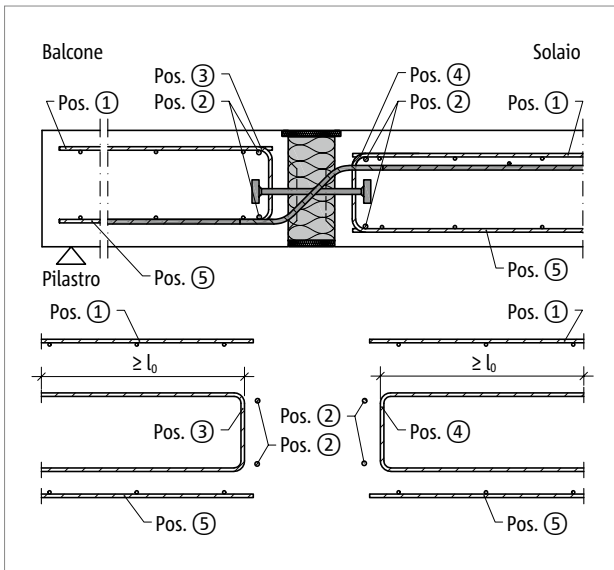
Schöck Isokorb® T tipo QP: armatura in opera
